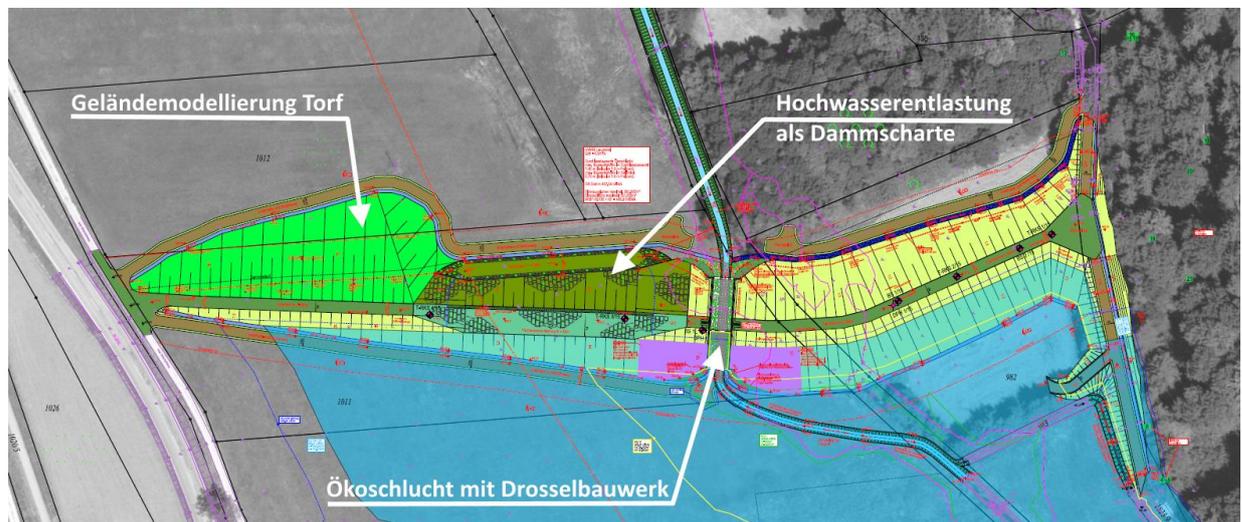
Planausschnitt (113474-22a-HW) Detaillageplan Dammbauwerk.
